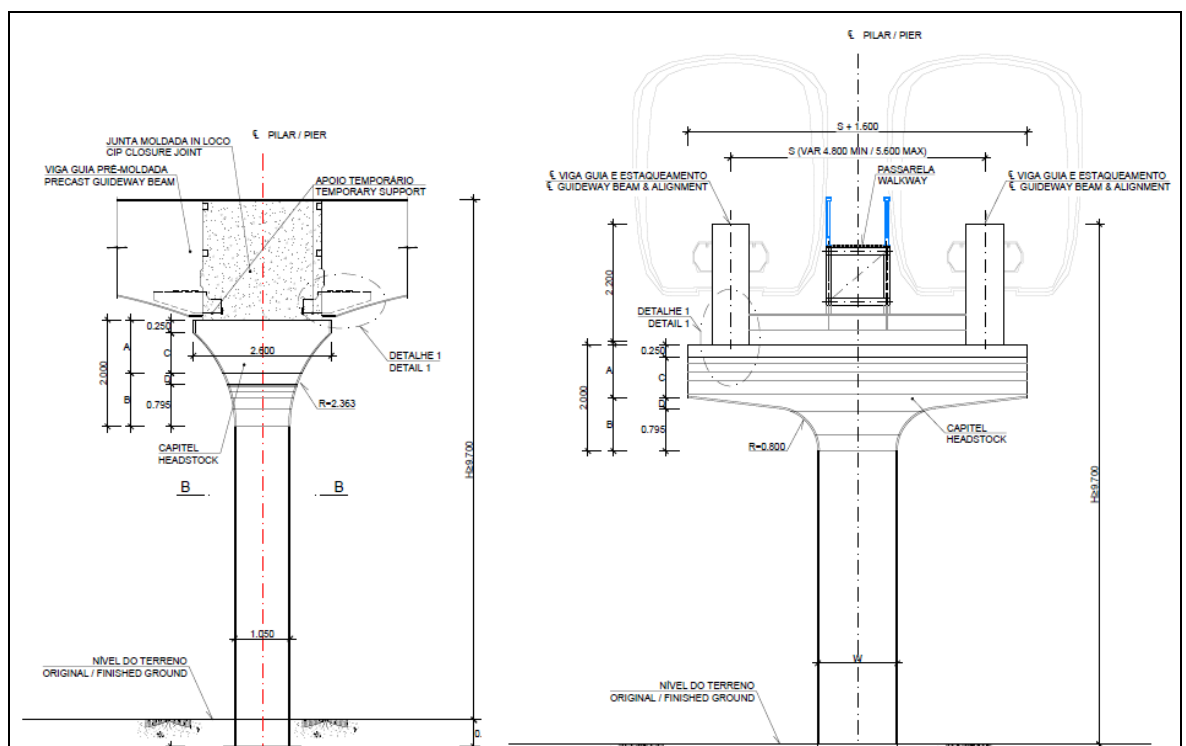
Forma Estrutura Via Elevada Tipo 1B (Planta DE-MG.00.EL_C.EC2-008).
